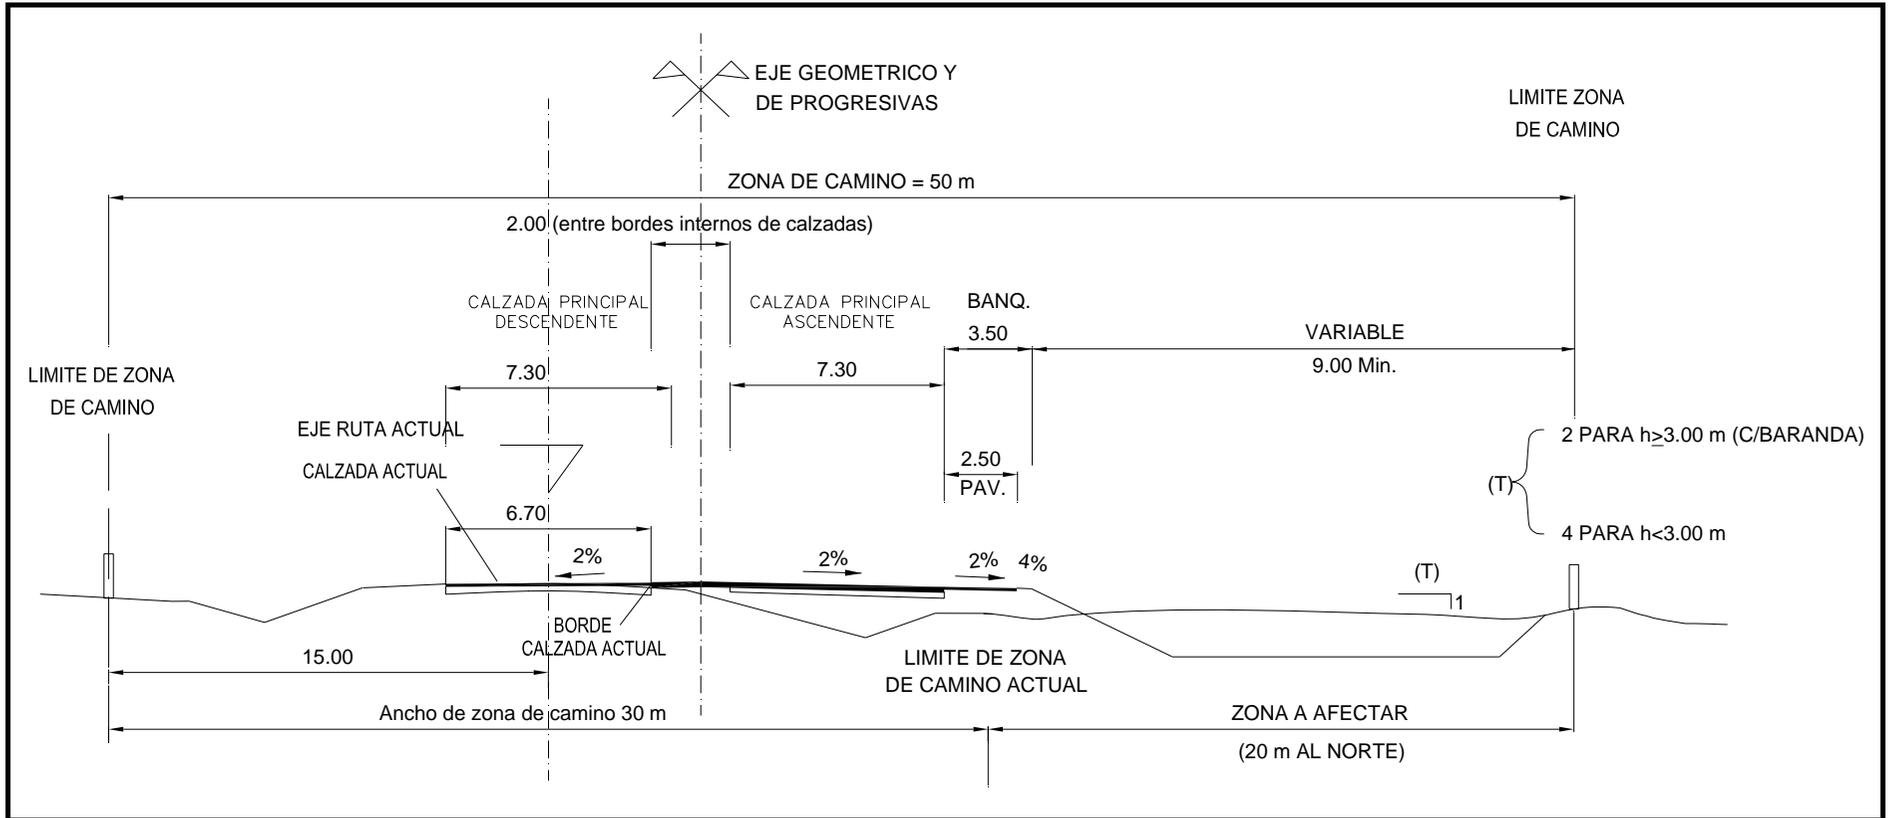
Croquis Tipo 3: perfil de diseño en zona Ru-urbana (Tramo 1, Sección 3)
